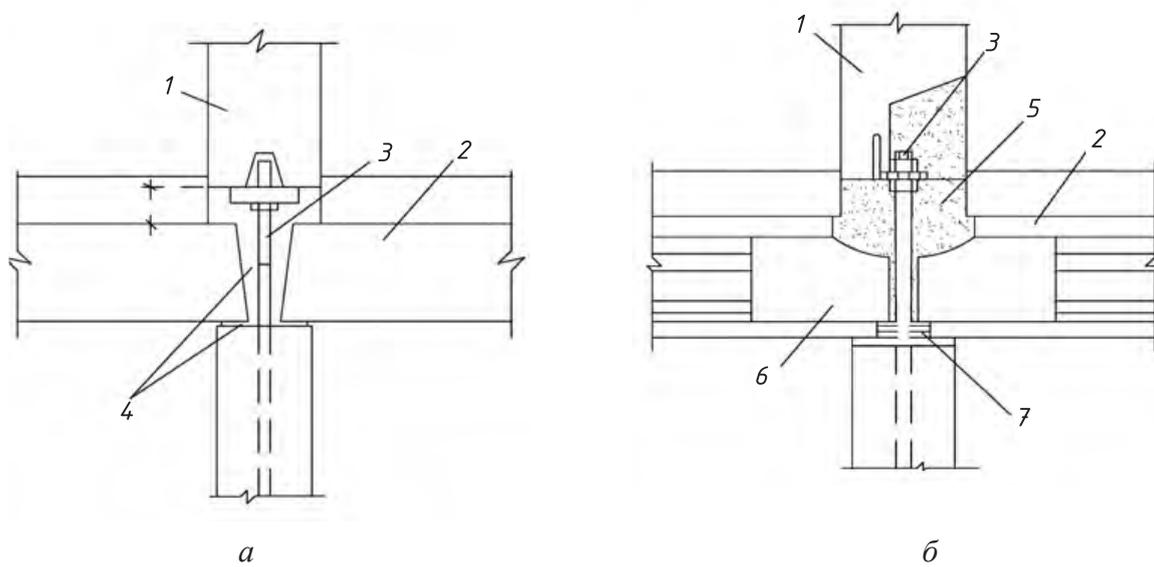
Платформенный стык на фиксаторах: *a* — с панелями перекрытий сплошного сечения; *б* — с многопустотными настилами: 1 — панель стены; 2 — панель перекрытия; 3 — фиксатор; 4 — цементный раствор (или паста); 5 — бетон замоноличивания; 6 — бетонные пробки в пустотах панели перекрытия; 7 — стык арматурных выпусков перекрытия
